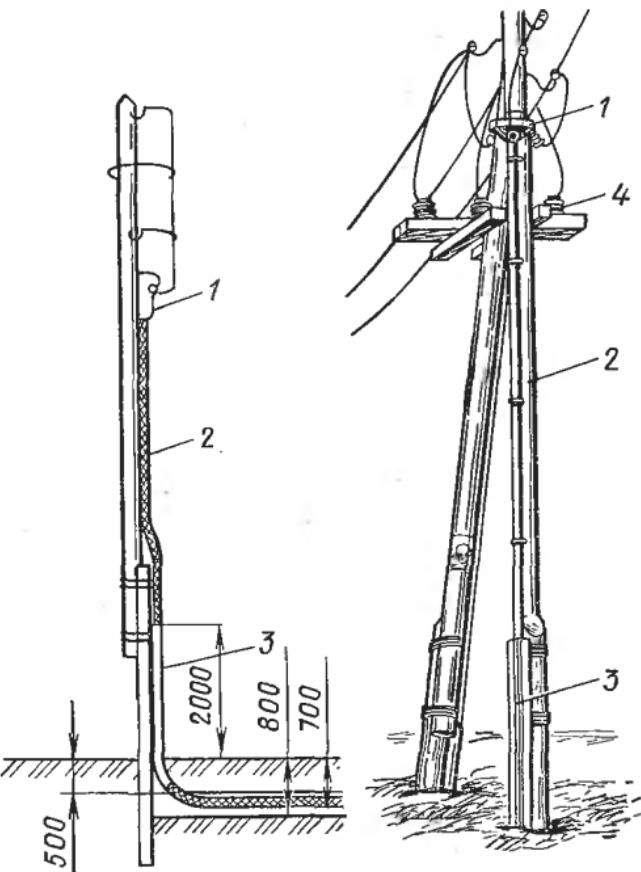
Вывод кабеля на опору для присоединения к ВЛ напряжением 10 кВ:
